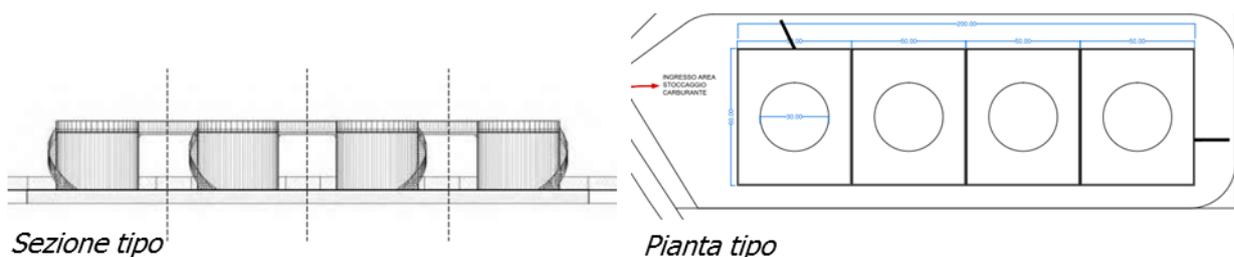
Deposito carburanti, sezione e pianta tipo (Fonte: Masterplan, Scheda interventi – Scheda 2.4)
